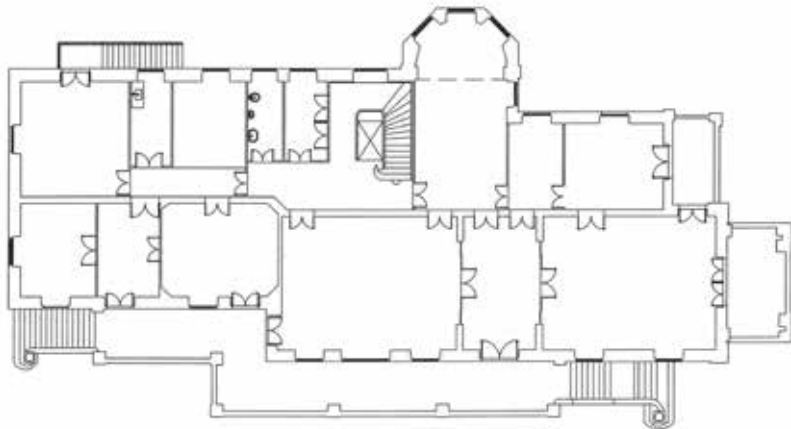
Levantamento cadastral da Villa Catharino. Planta Baixa do primeiro pavimento. Fonte: JORDAN et alli. 2006, p. 93.
